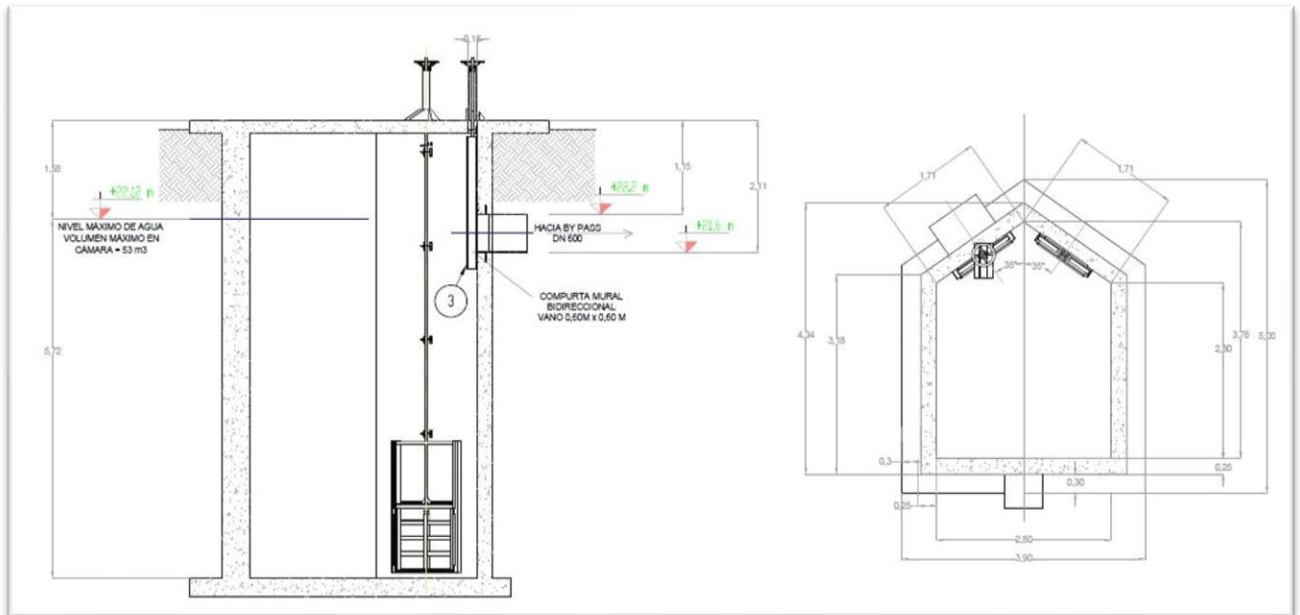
Vista del plano en corte y transversal de la cámara de ingreso. Fuente OPISU.
